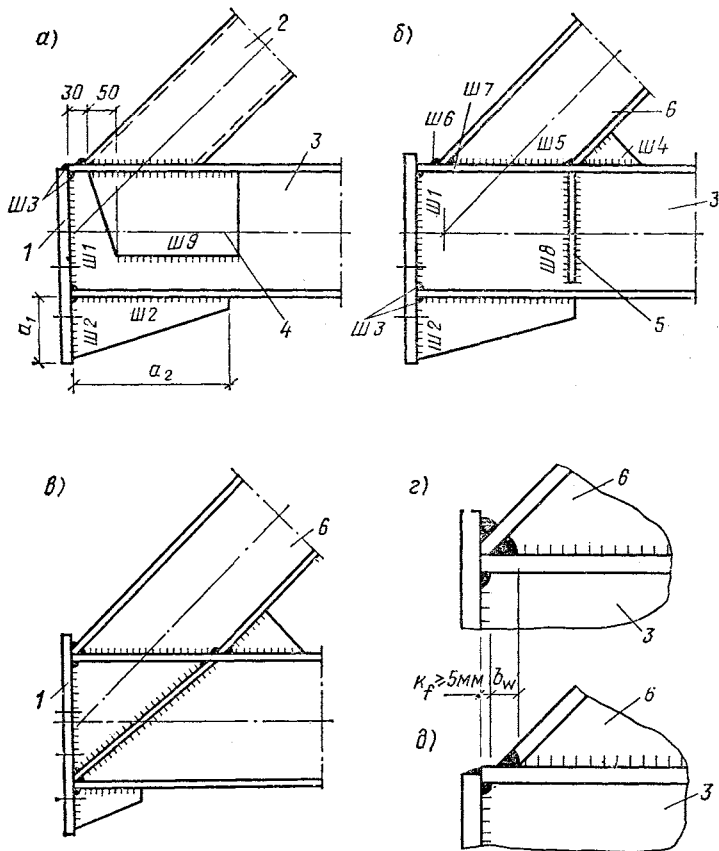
Опорные узлы фермы с поясами из ШПД и восходящими опорными раскосами
